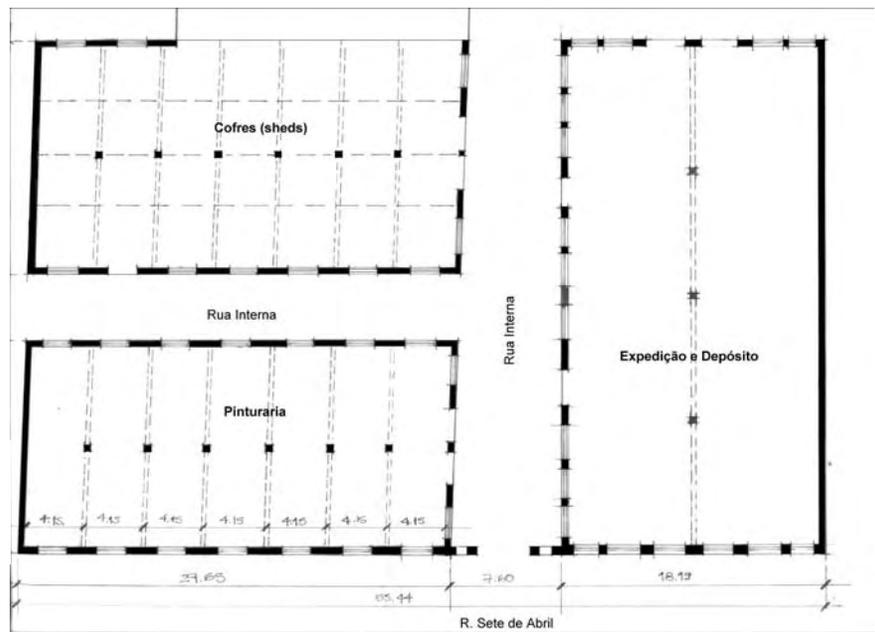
Plantas baixas dos pavilhões de produção da Wallig. Wiederspahn, 1920.
